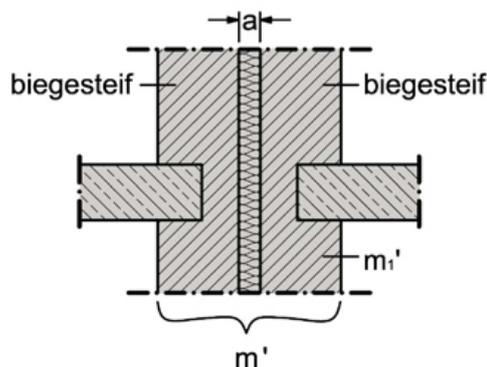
Zweischalige Gebäudetrennwand mit durchgehender Trennfuge
